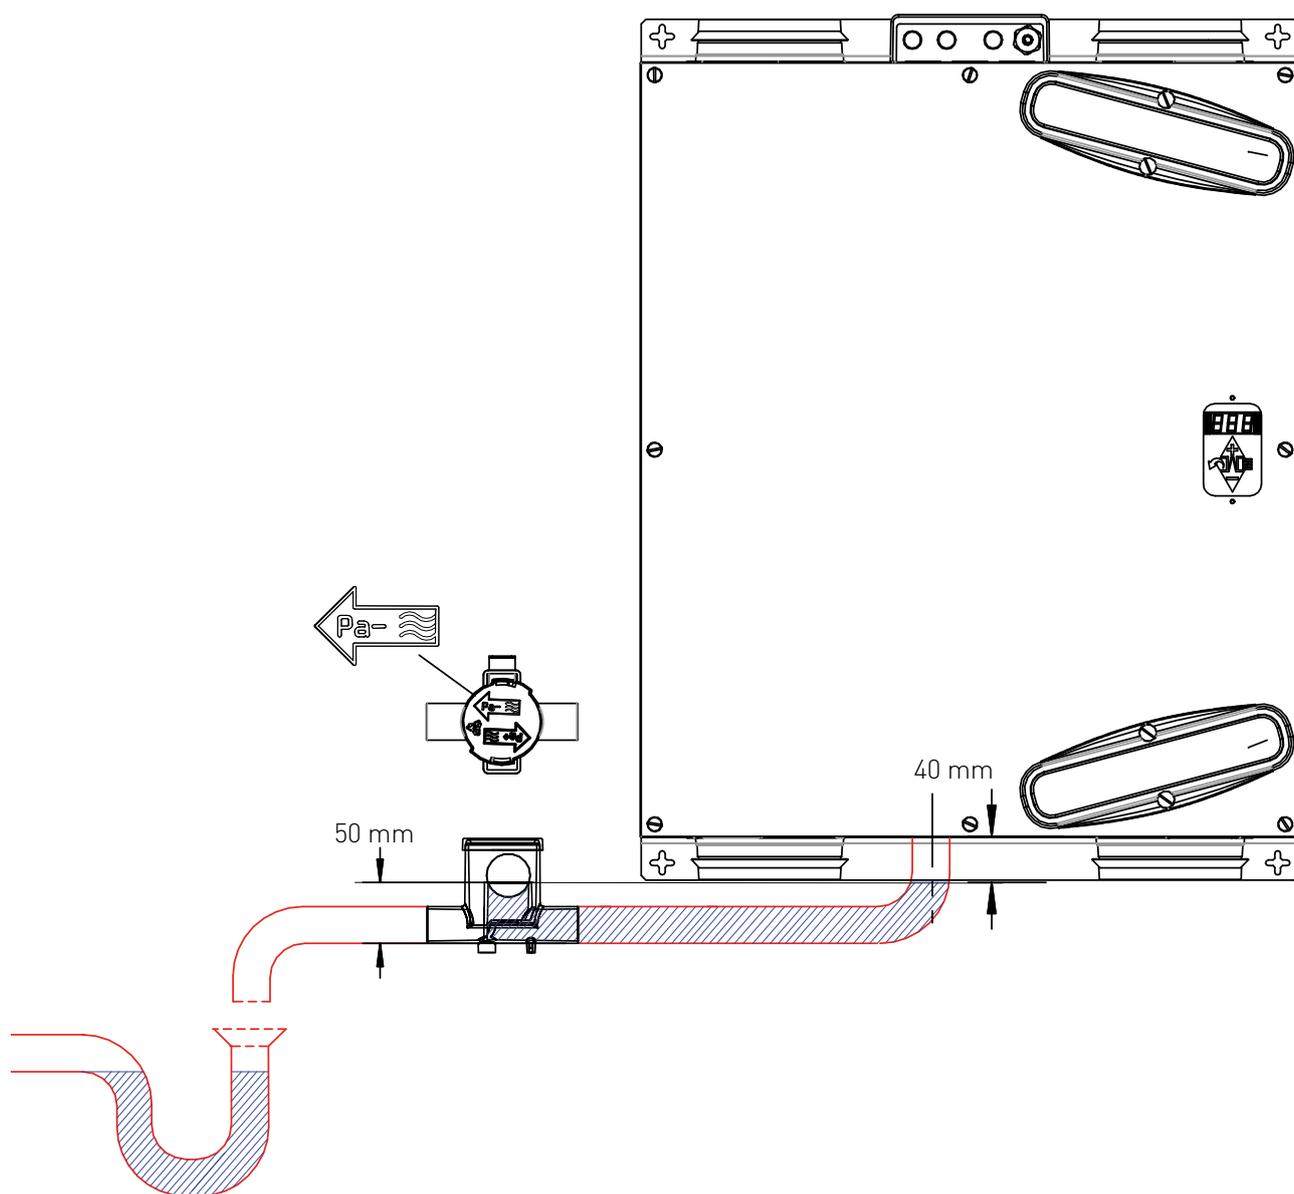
A: MONTAGE PLAFOND AVEC COUPE-AIR
